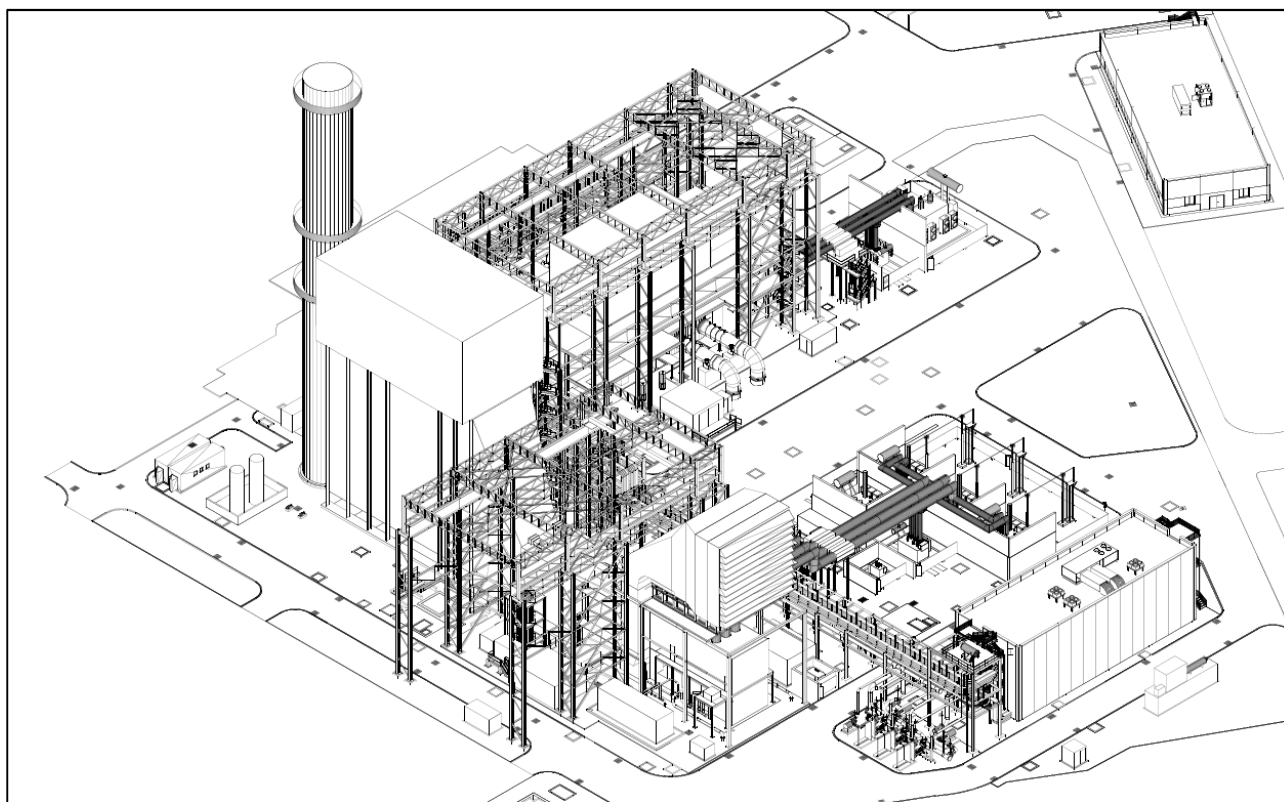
Vista della Centrale con la struttura reticolare contenente la turbina a vapore aperta
